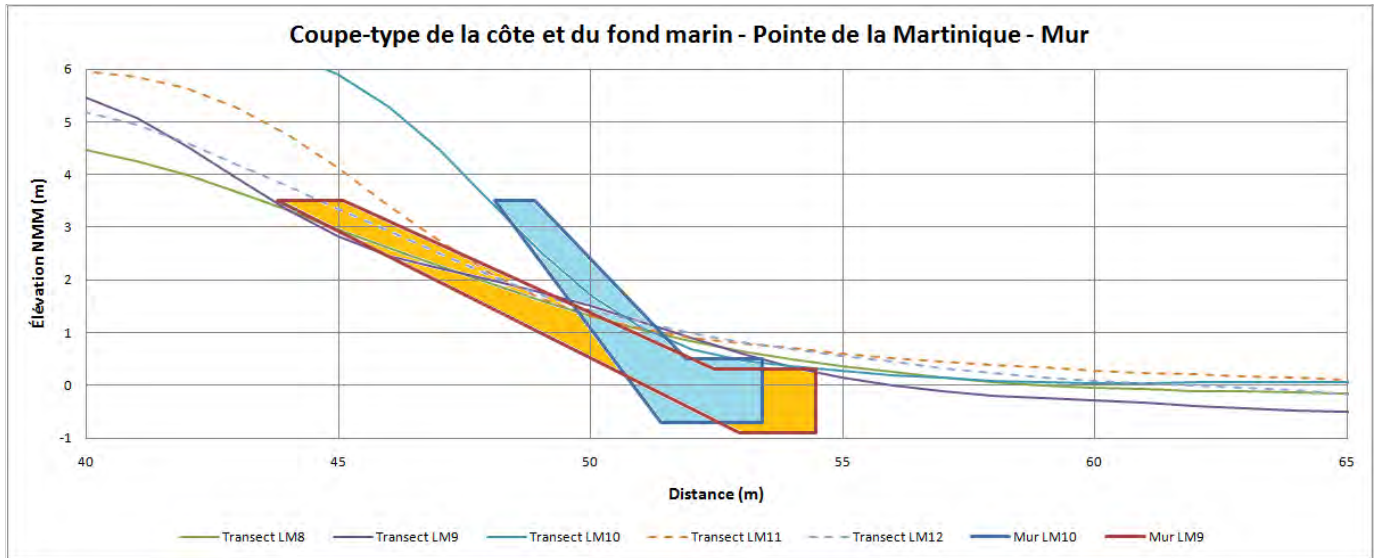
Coupe type d'une protection en béton armé du pied des falaises de la Pointe de la Martinique
